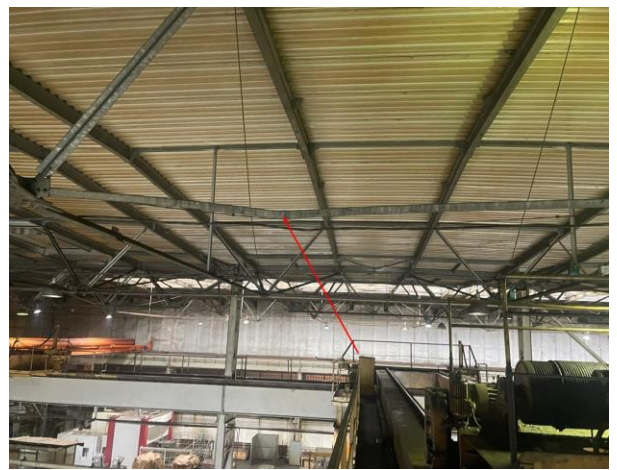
Прогиб элемента конструкции покрытия по нижнему поясу.
